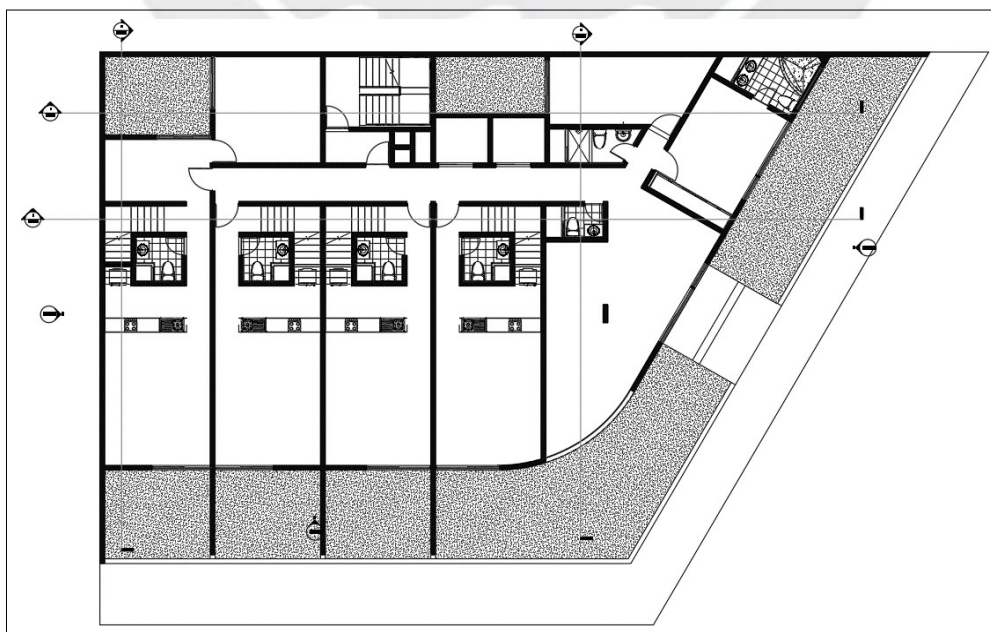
Esquema inicial del edificio– Plano arquitectónico.
